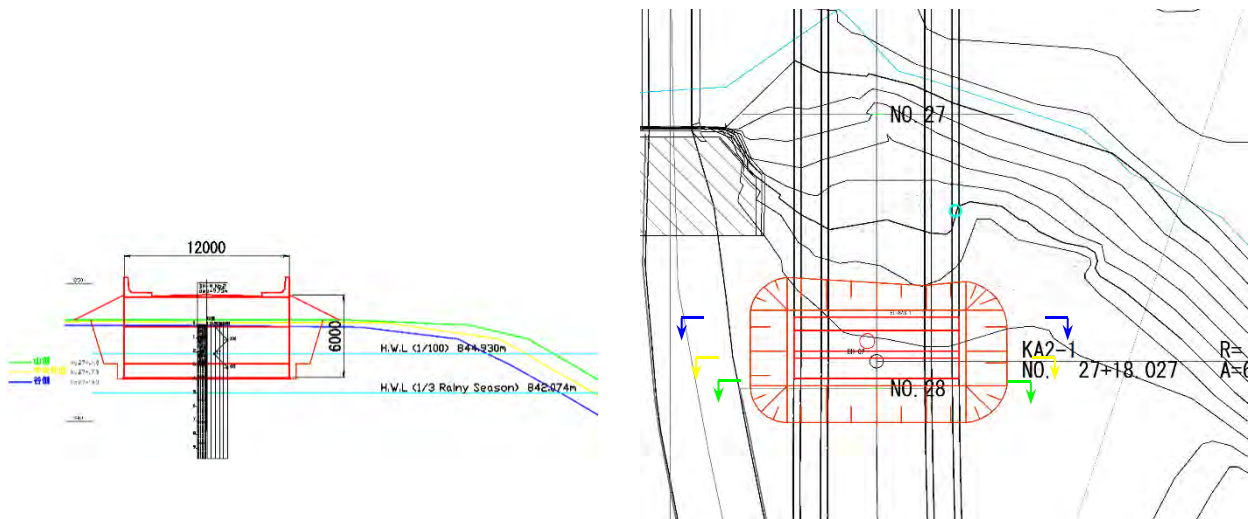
A2 橋台位置の比較案 (横断面及び平面図)
